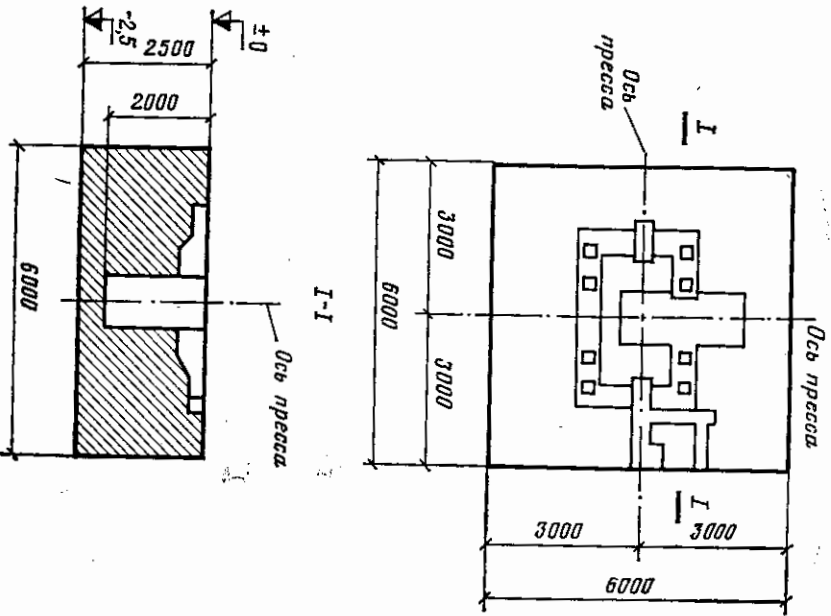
Фундамент под винтовой пресс (план и разрез)
